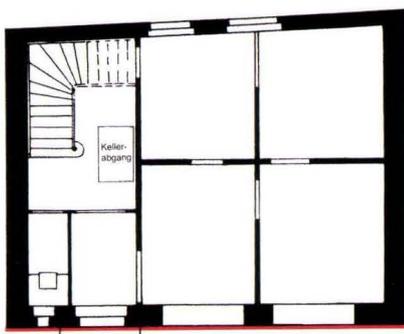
Ochsen-gasse 16. Grundriss des Erdgeschosses im Zustand von 1897. Markiert ist die Strassenfassade. – Plangrundlage Staatsarchiv Basel-Stadt. Bearbeitung: Stephan Tramèr.
